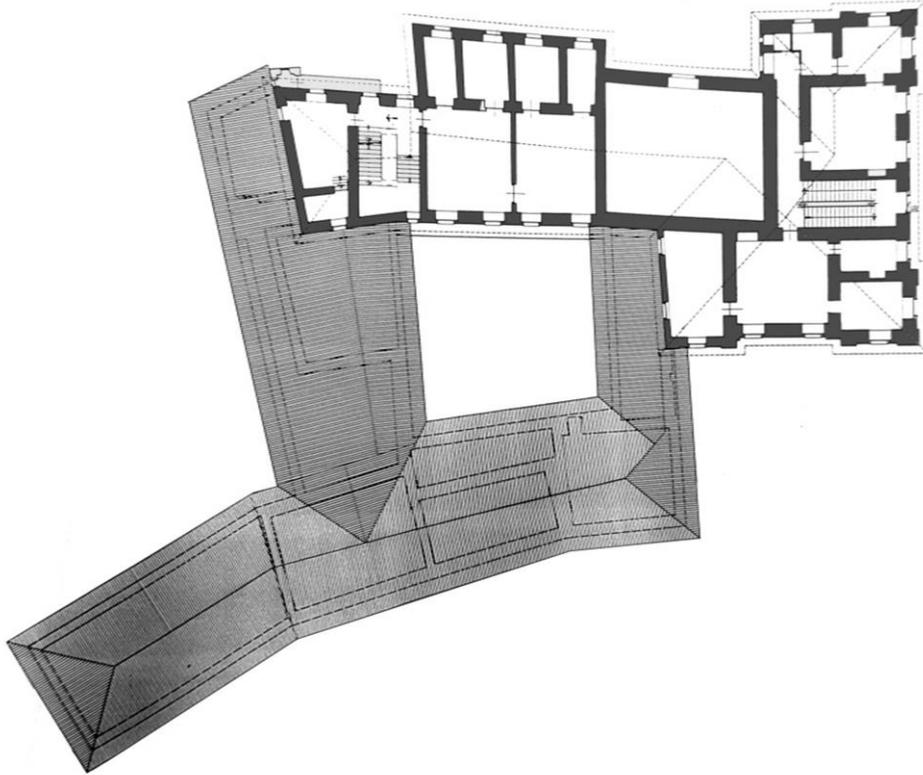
Planimetria Palazzo Canalis secondo piano (Comune di Cumiana).
